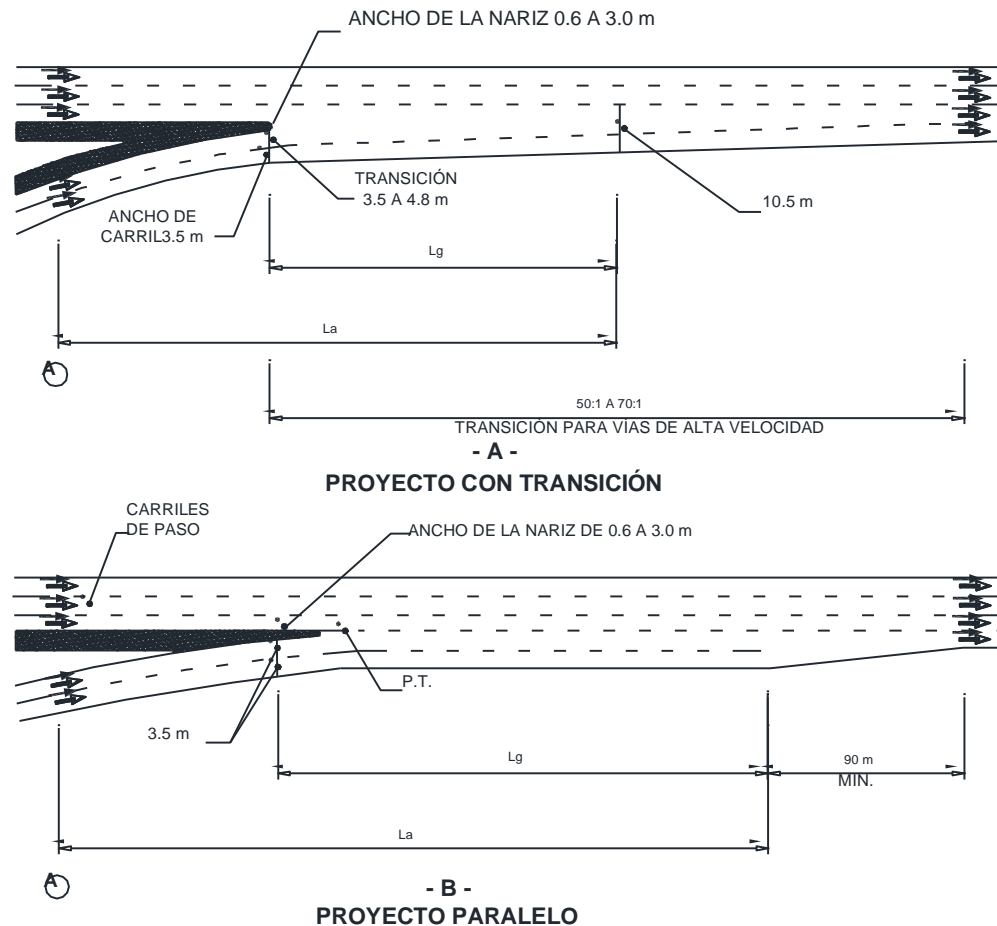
Rampas típicas de entrada de dos carriles
